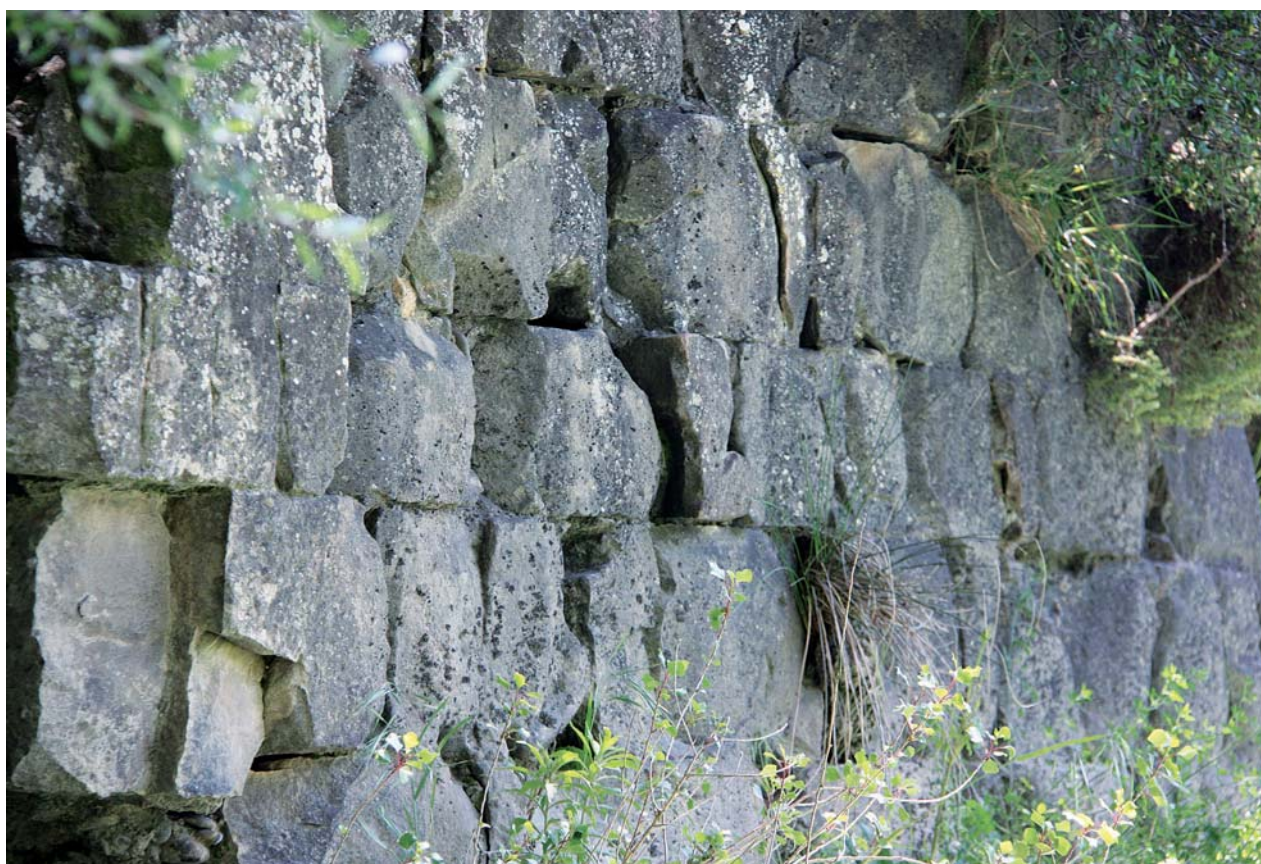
Restos constructivos junto al emplazamiento del molino.
